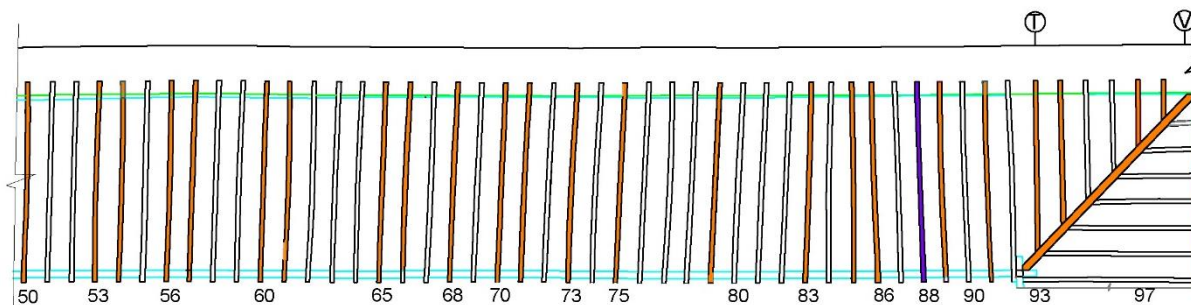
Propuesta de solución al forjado entre vigas 50-98
